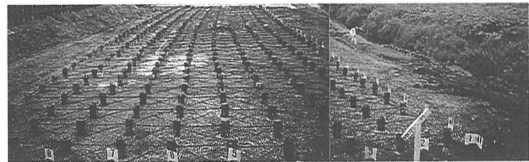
パイルネット施工状況 (十勝川支川下頃辺川左岸)
